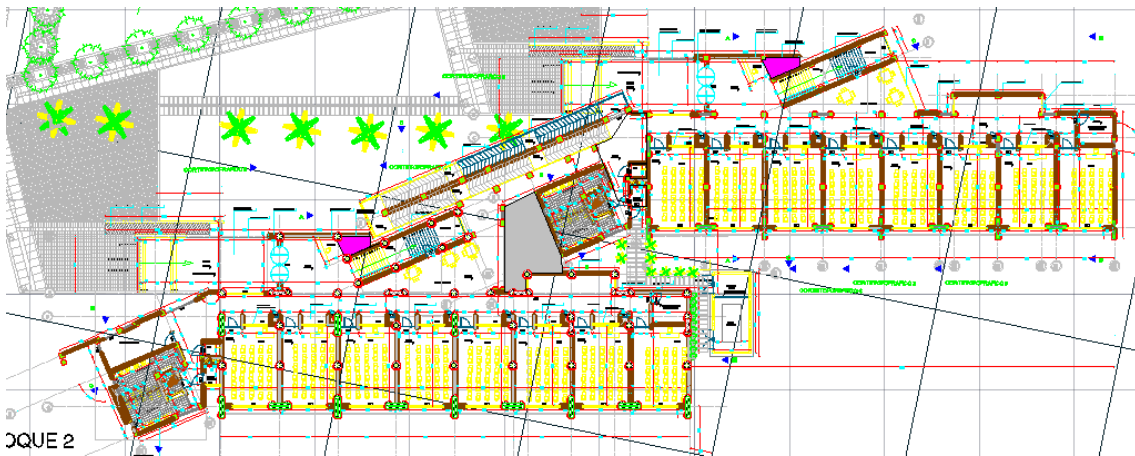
Planta general bloques aulas y baterías AUTOCAD
